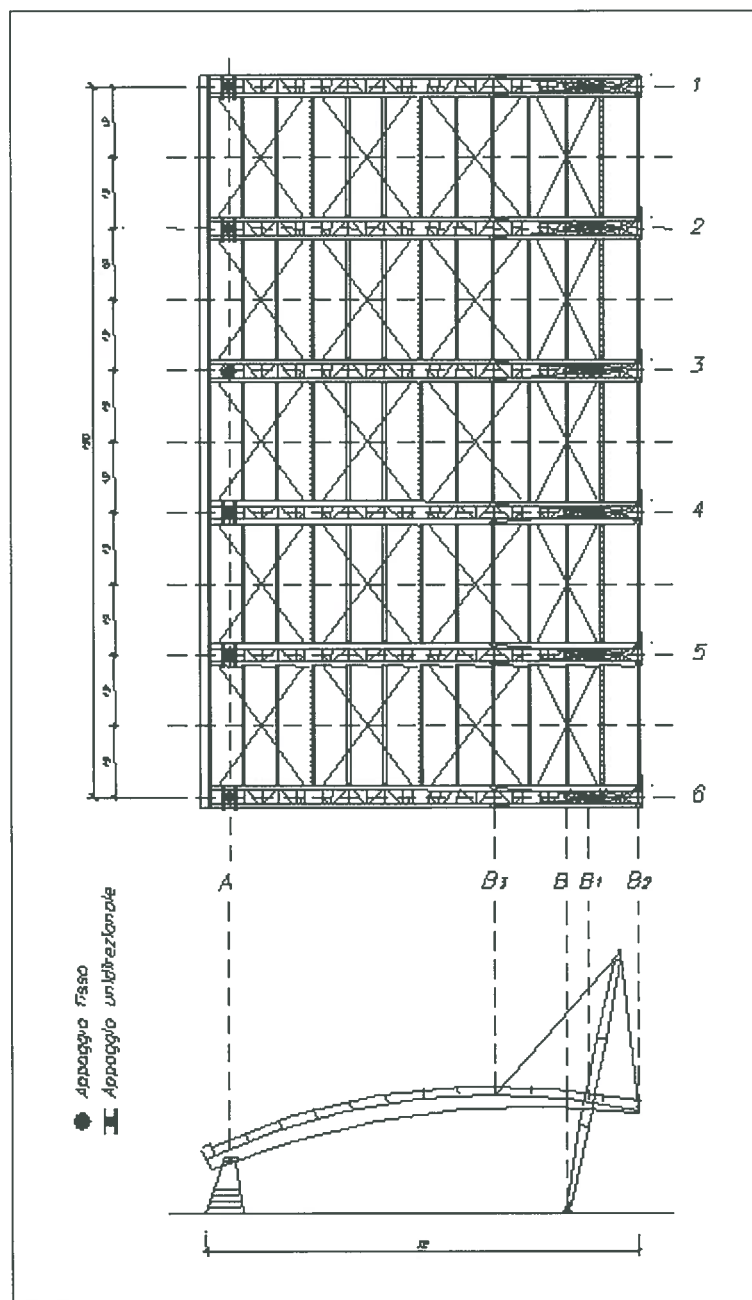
Schema planimetrico e sezione schematica della copertura
